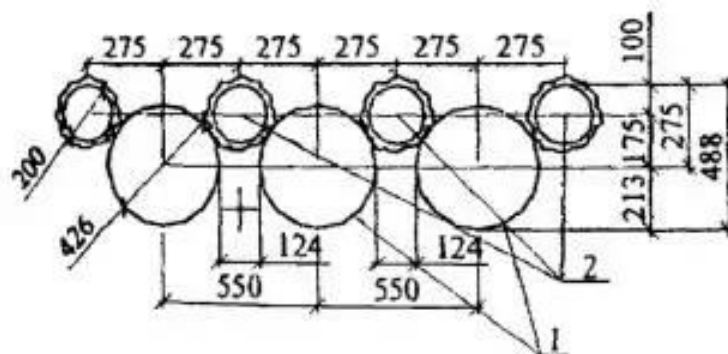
План ограждения котлована конструкций из 2-х рядов свай. 1 - несущие металлические сваи; 2 - тампонирующие буротрамбованные сваи.
